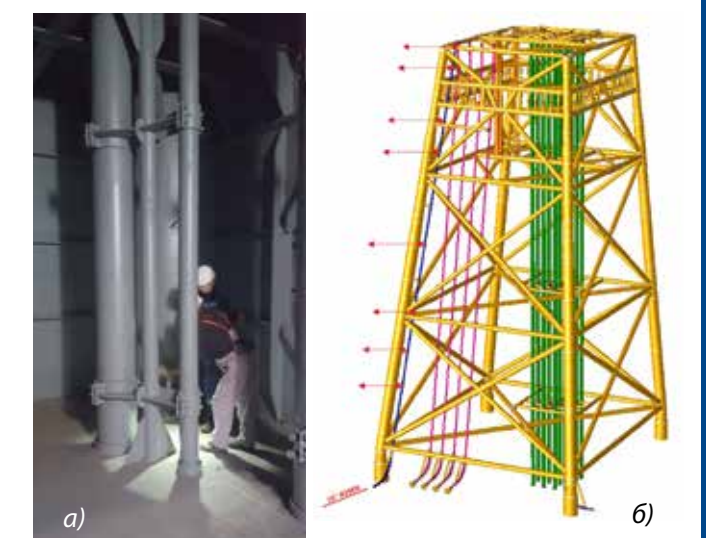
Примеры конструктивного оформления стояка (а) и райзера (б) (для райзера стрелками показаны узлы его крепления стойке опорного блока)
